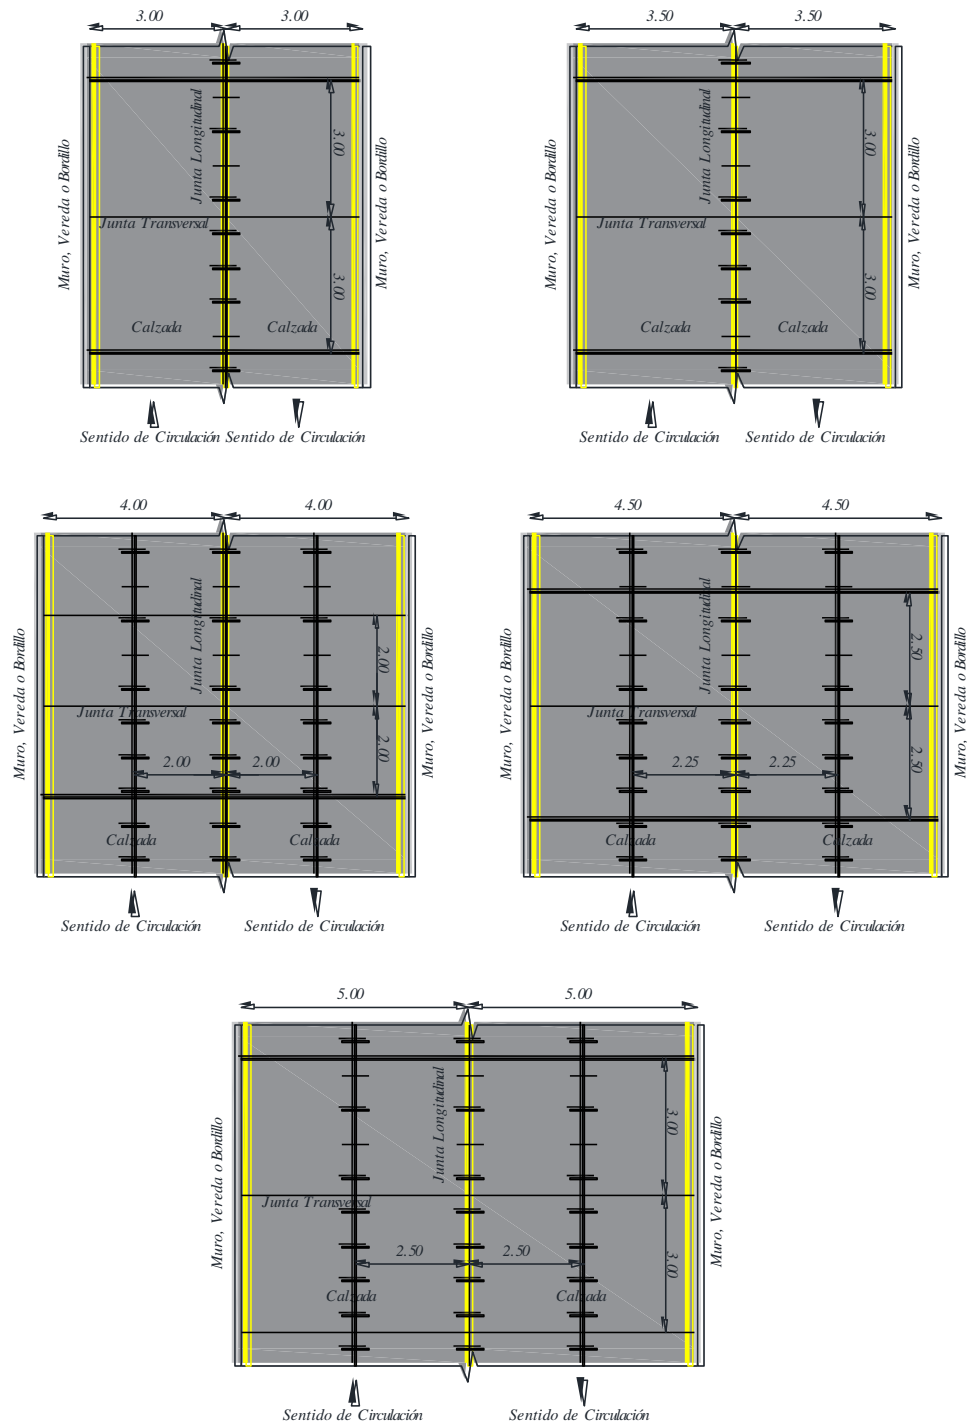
Dimensiones típicas de las losas de pavimento rígido
